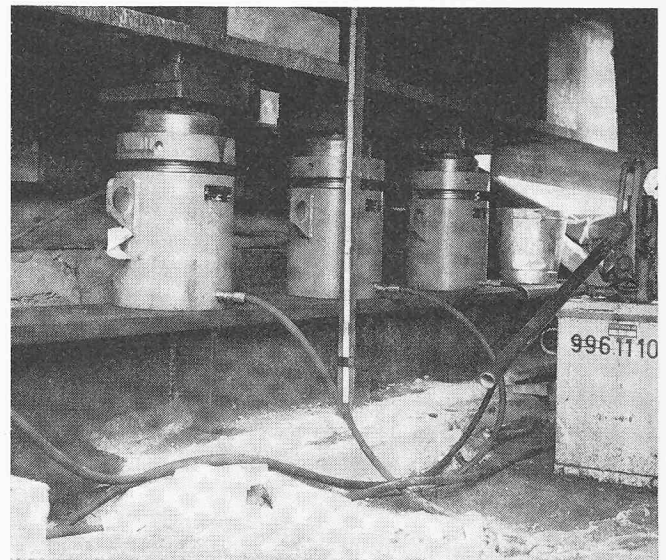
Drei Pressen zu je 200 t übertragen die Last auf das Schlitzwandelement
